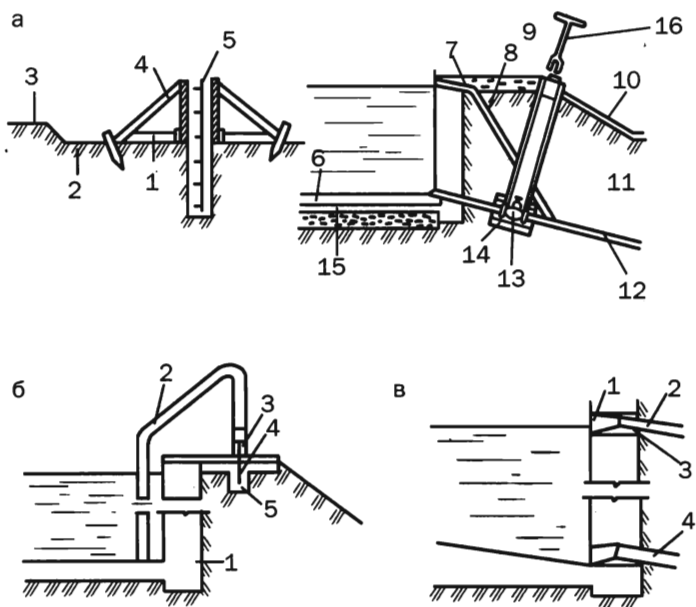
Конструкция бассейна: а — схема устройства конструкции:
